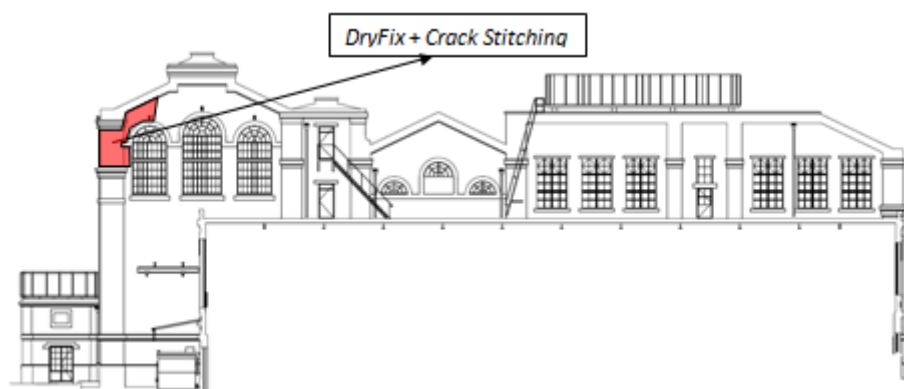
Zona de consolidação dos panos de alvenaria. Fachada Nascente da BP.
